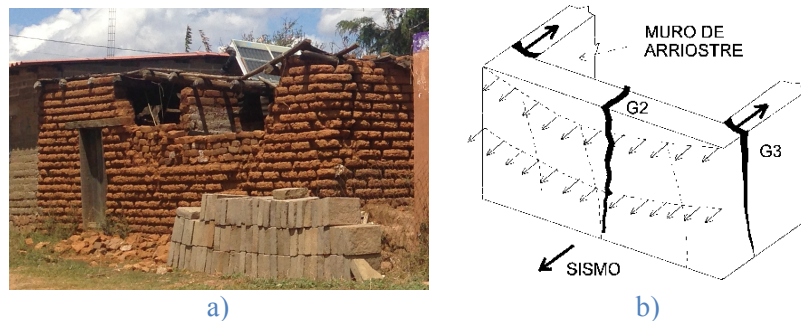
Tipos de falla; a) falla fuera del plano (2016) y b) falla sísmica por acción perpendicular al plano, desgarramiento vertical en las esquinas y grieta vertical por flexión en la zona central del muro ([San Bartolomé *et al.*, 2015](#)).
